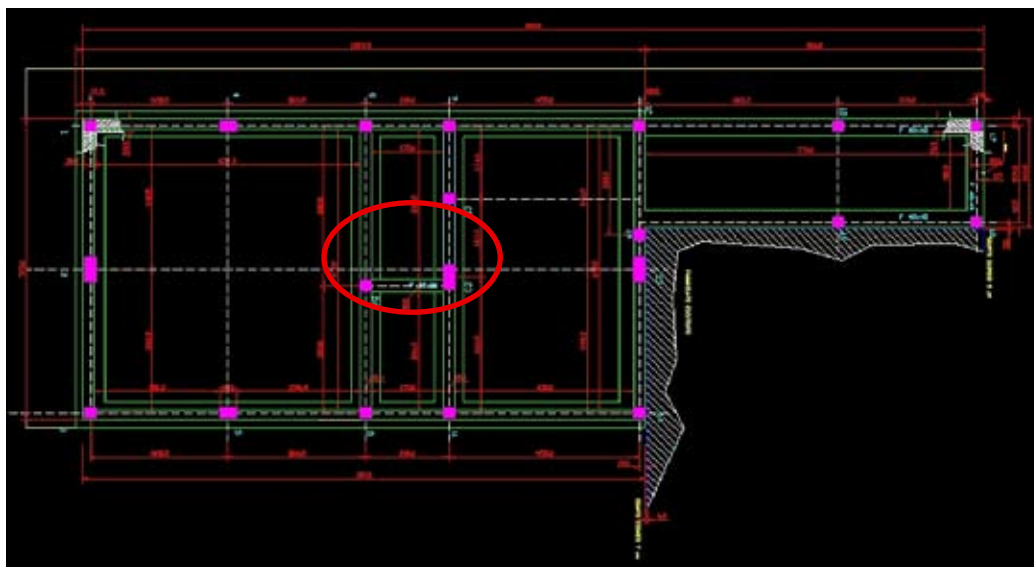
Pianta della fondazione con distribuzione della pilastratura per l'ipotesi "A" (soluzione intelaiata in c.a.), con evidenziati i pilastri che restano a "vista".
